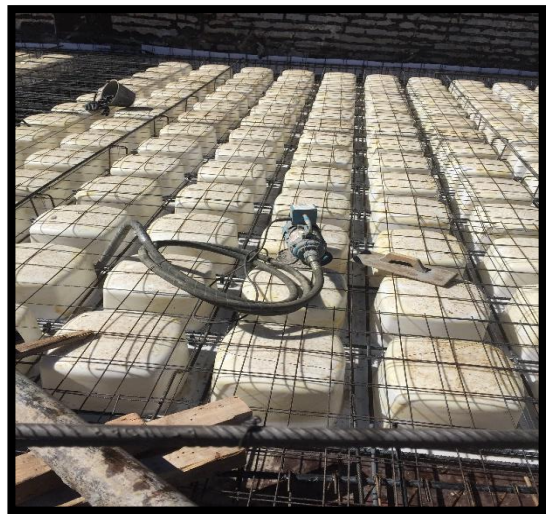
Armado de losa nervurada con casetones recuperables. Hormigonado de la misma, vibrado y "regleado" del hormigón
